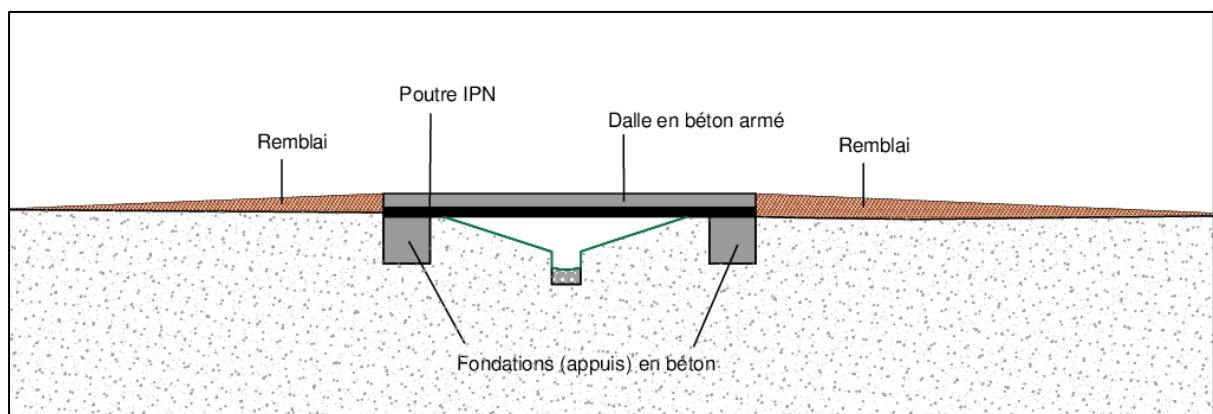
Eléments constitutifs d'une passerelle mixte métal - béton
